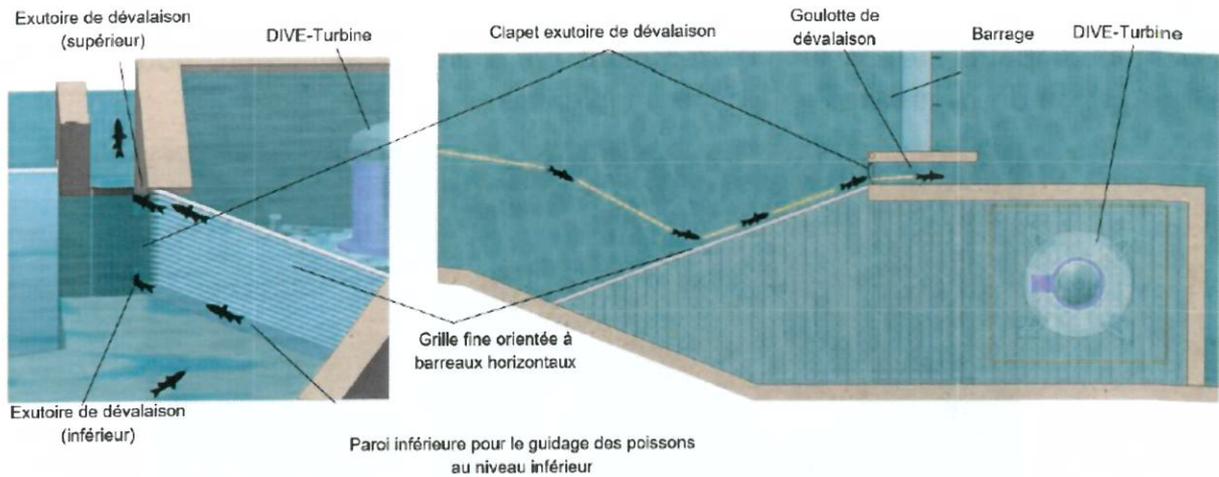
Solution de prise d'eau avec plan de grille vertical.
